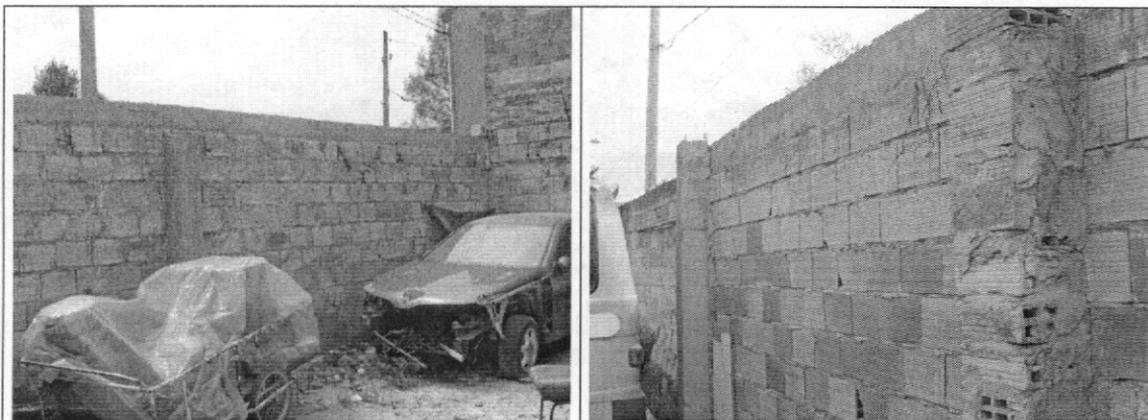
Aspecto de un tramo del cerramiento en mampostería de bloque hueco
